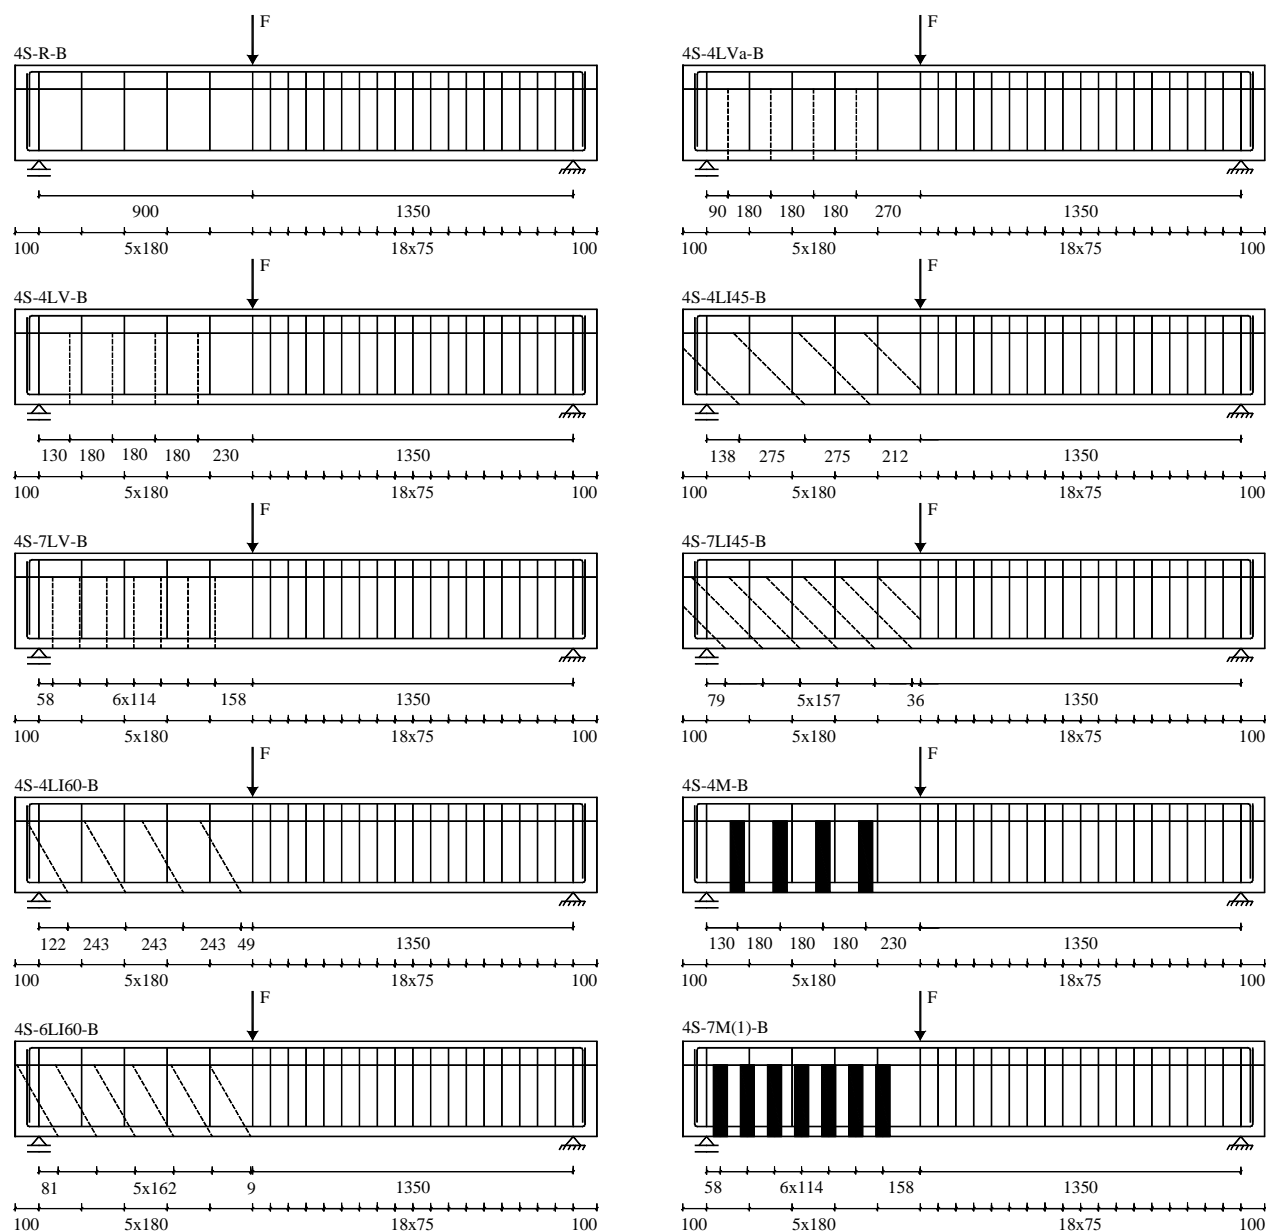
(cont.) - Vigas ensaiadas da série B: localização das armaduras transversais (linha a traço cheio) e dos laminados de CFRP no reforço ao corte (linha a tracejado).
